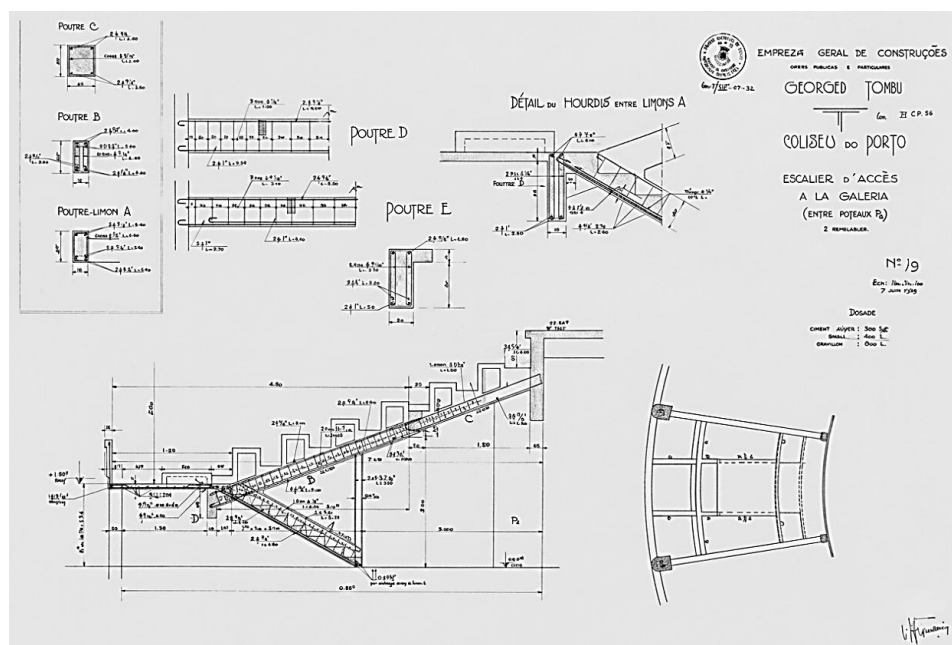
Pormenores de construção de escadas de acesso à galeria, em betão armado, por George Tombu [63].
